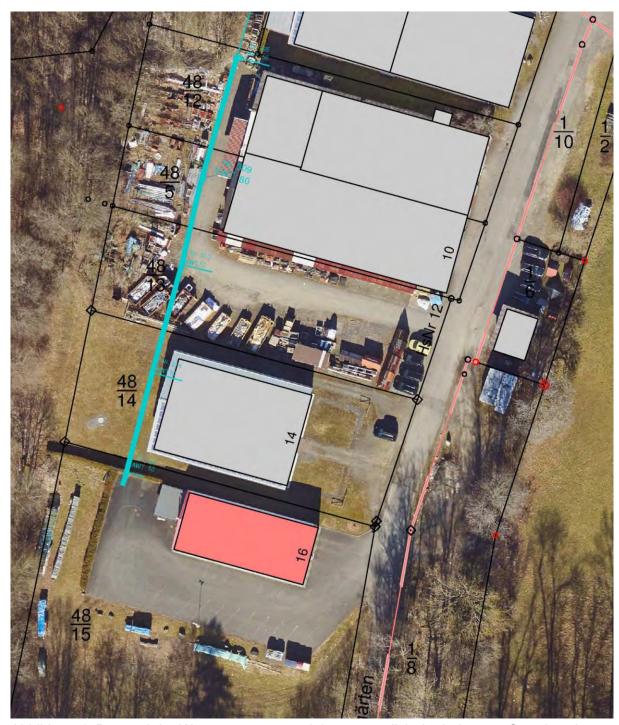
Bestand der Wasserversorgungsleitung, westlich der bebauten Grundstücke gelegen (siehe hellblaue Linie)
